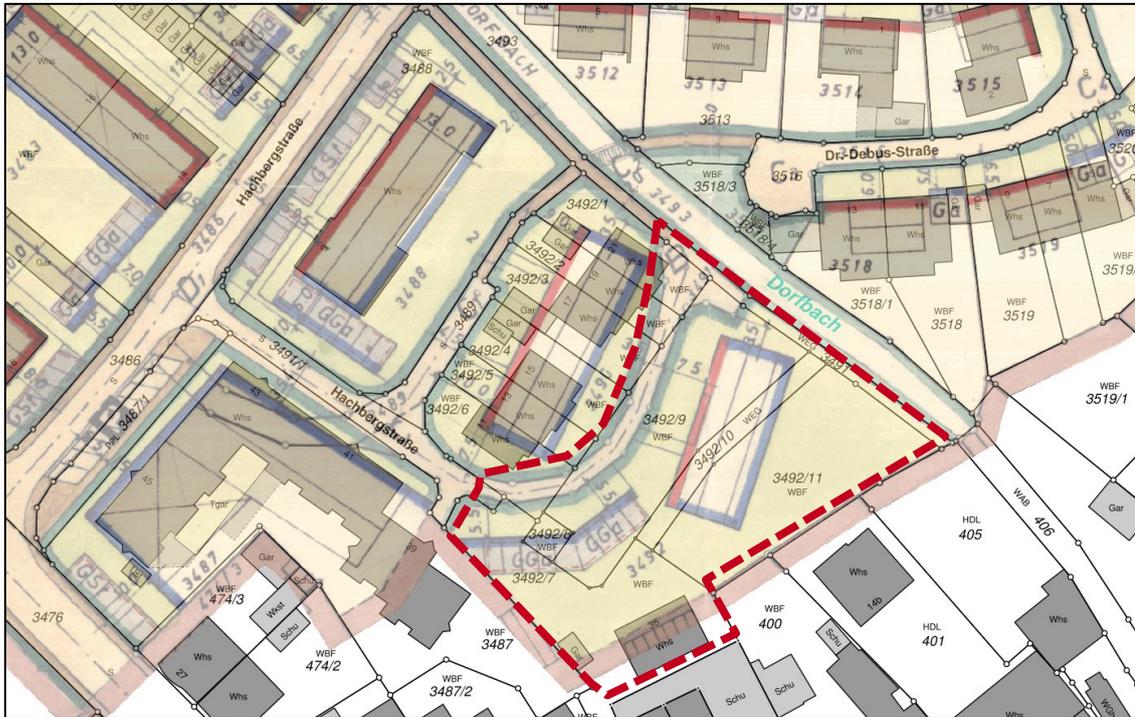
und 3: Bestehender Bebauungsplan und Gestaltungsplan jeweils Umgrenzung des Plangebiets. Quelle: Stadt Lörrach, eigene Darstellung
